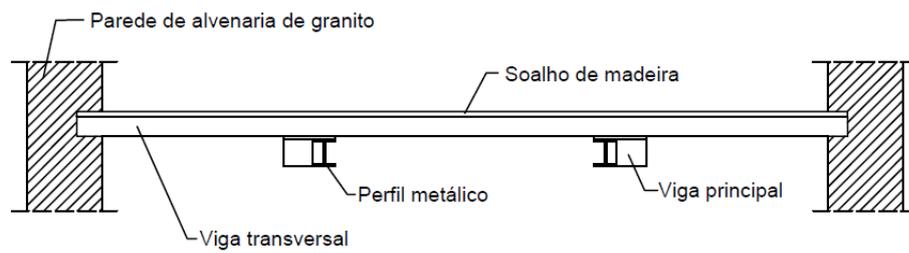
Esquema de reforço na zona de apoio da ligação das vigas à parede de alvenaria [70]
